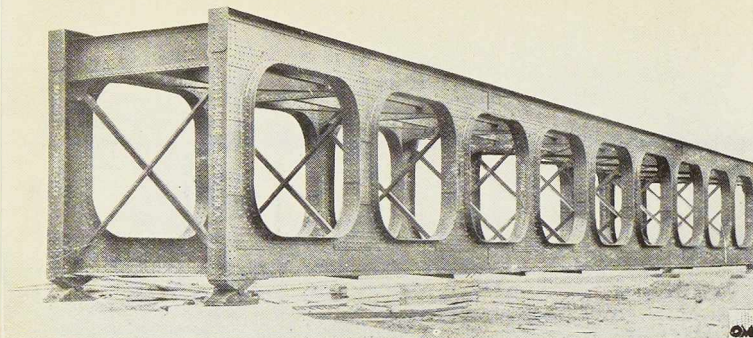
Pont d'essai de Tervueren de 32 mètres, construit en 1897.
